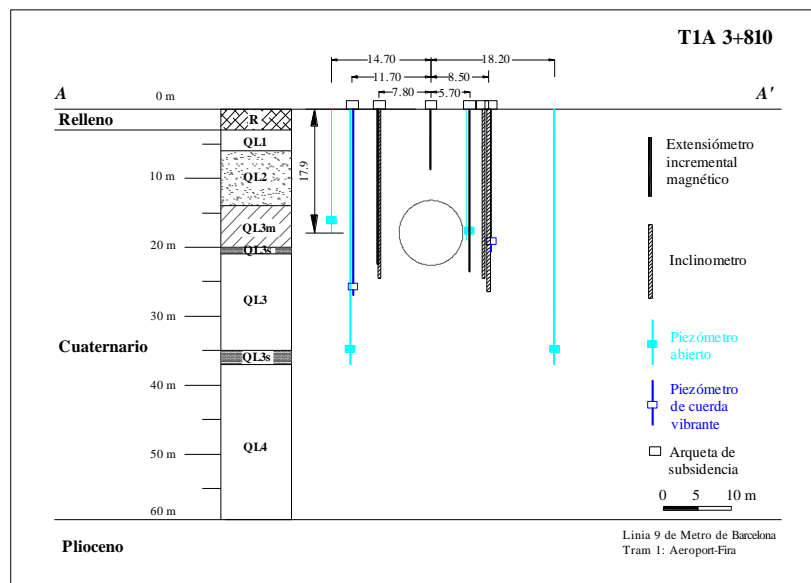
19. Perfil de la sección instalada en la sección de control T1A PK 3+810
